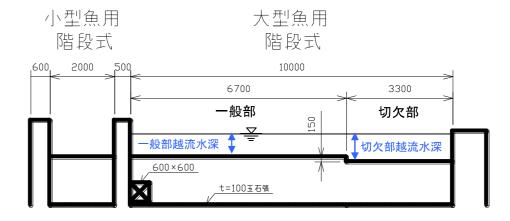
宮中ダムに現在設置されている階段式魚道の横断面図
